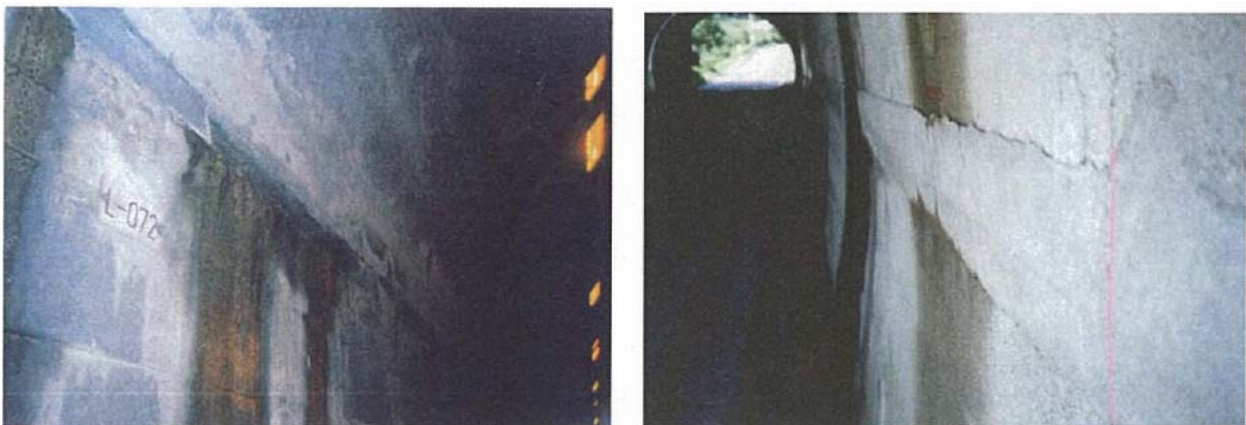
逆巻き工法の縦断方向打ち継目と化粧モルタルの施工状況
